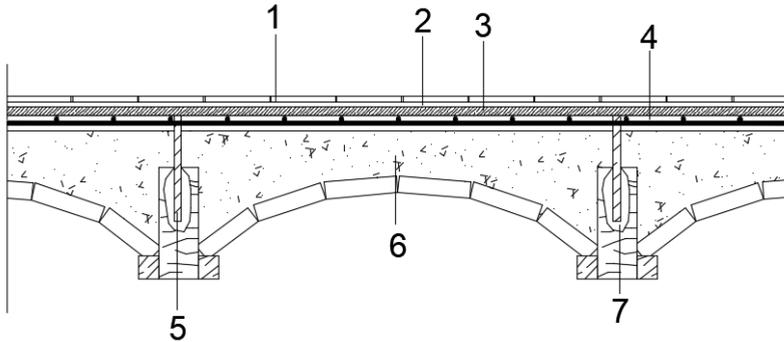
Detalle refuerzo forjado unidireccional. Fuente: Propia de la autora
